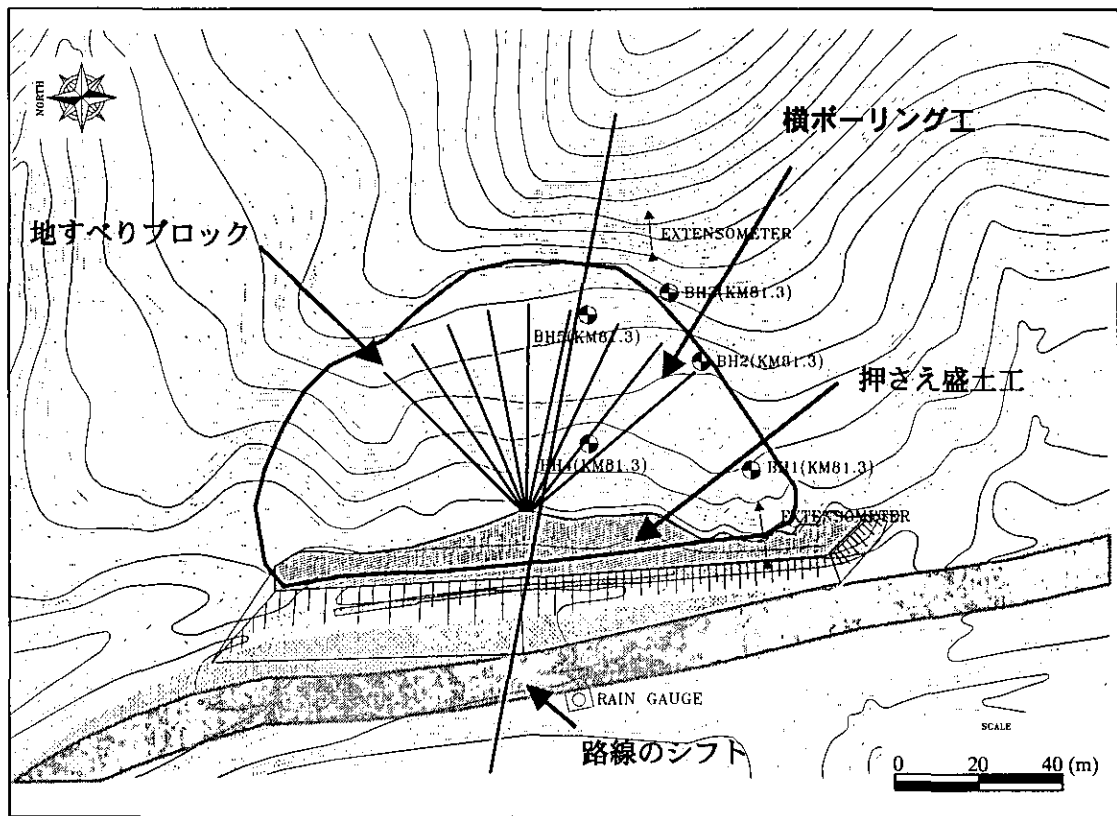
81.30km 対策工平面図 (押しえ盛土工および横ボーリング工)
